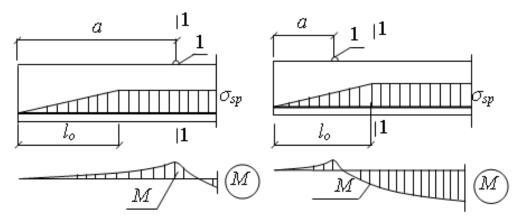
К определению момента M при расчете в стадии предварительного обжатия a) - когда $a > l_p$ б) - когда $a < l_p$; l-l - расчетное сечение; l - монтажная петля
